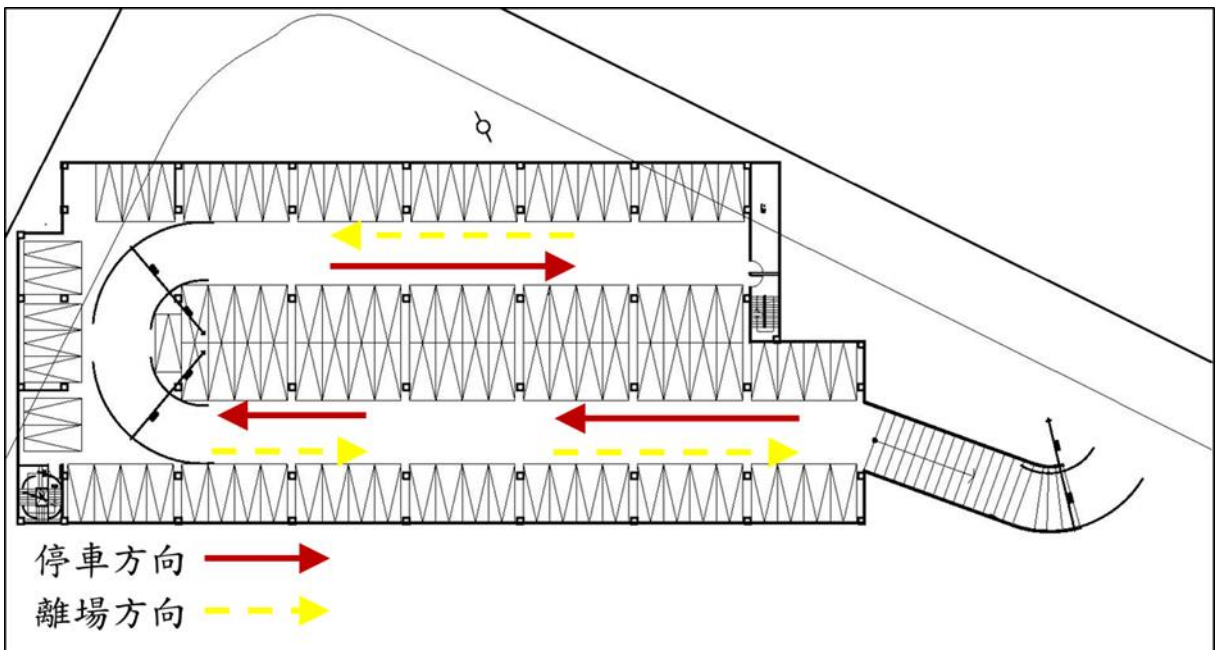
塘岐聚落地下停車場地下一層平面圖
